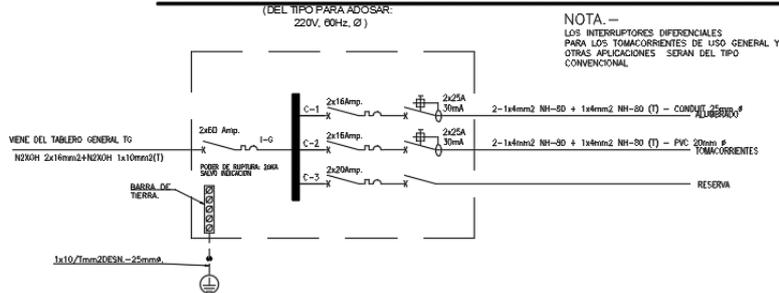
Detalle de Puesta a Tierra.
